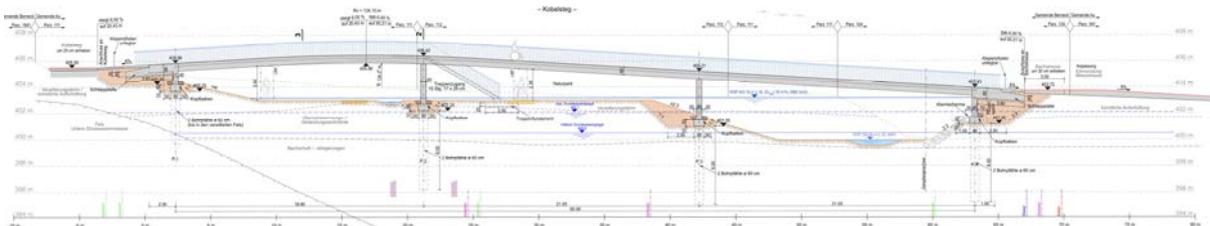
Vertikale Linienführung des Kobelstegs, Littenbach
